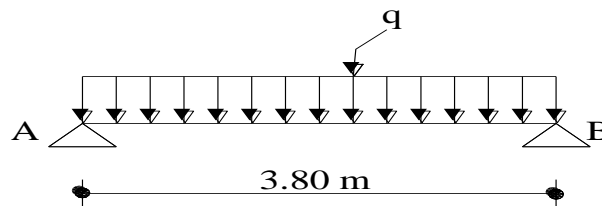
Schéma statique de la poutre palière de l'escalier type 2 .
